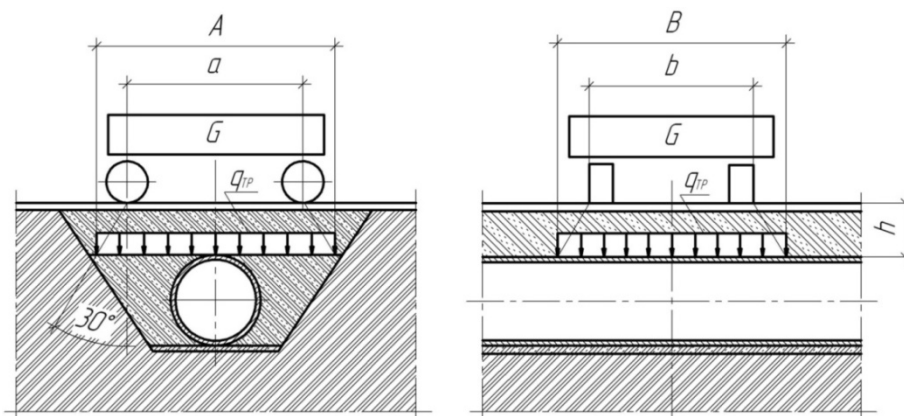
Схема нагружения трубопровода транспортной нагрузкой
